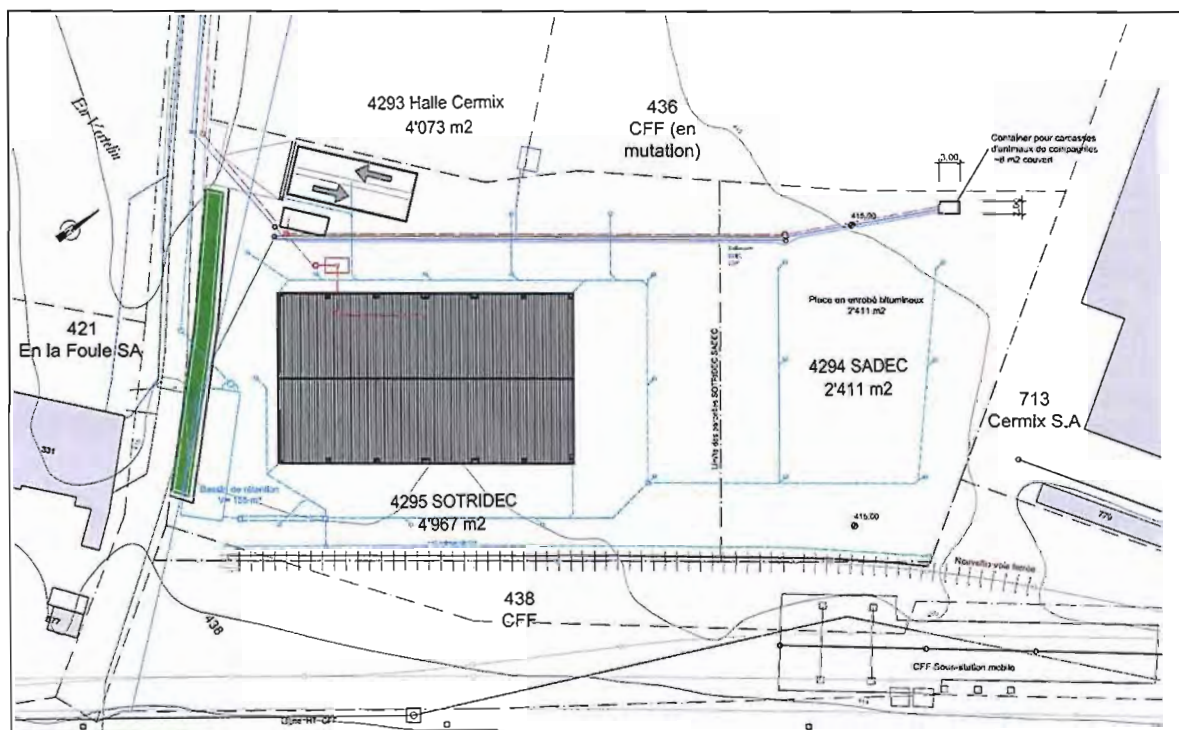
Plan de situation des projets SADEC/SOTRIDEC
